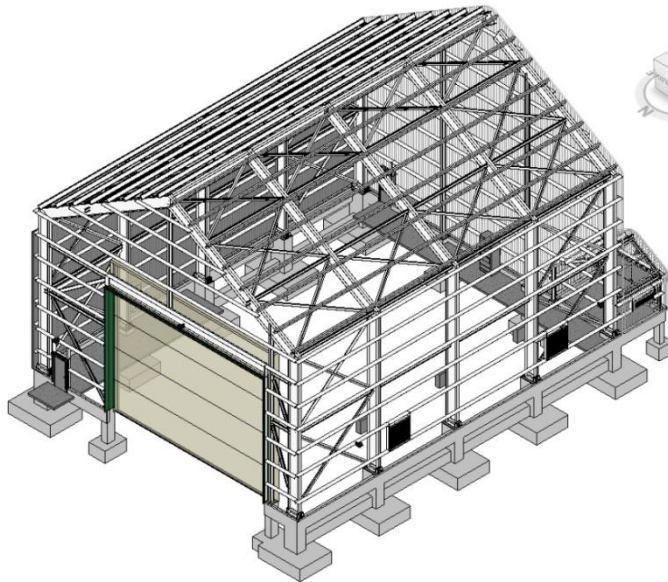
Esqueleto de una estructura industrial con cubierta de acero.
